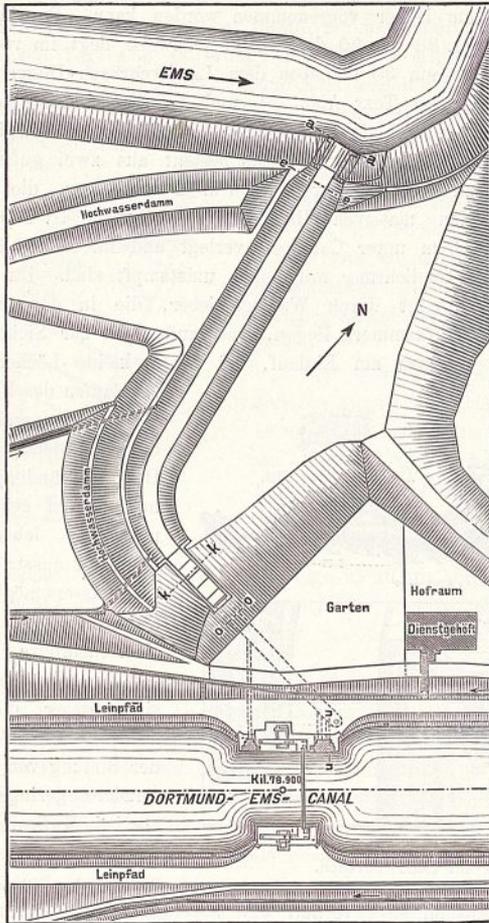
Lageplan des Sicherheitsthores mit Entlastungsanlage in Kil. 78,9.
